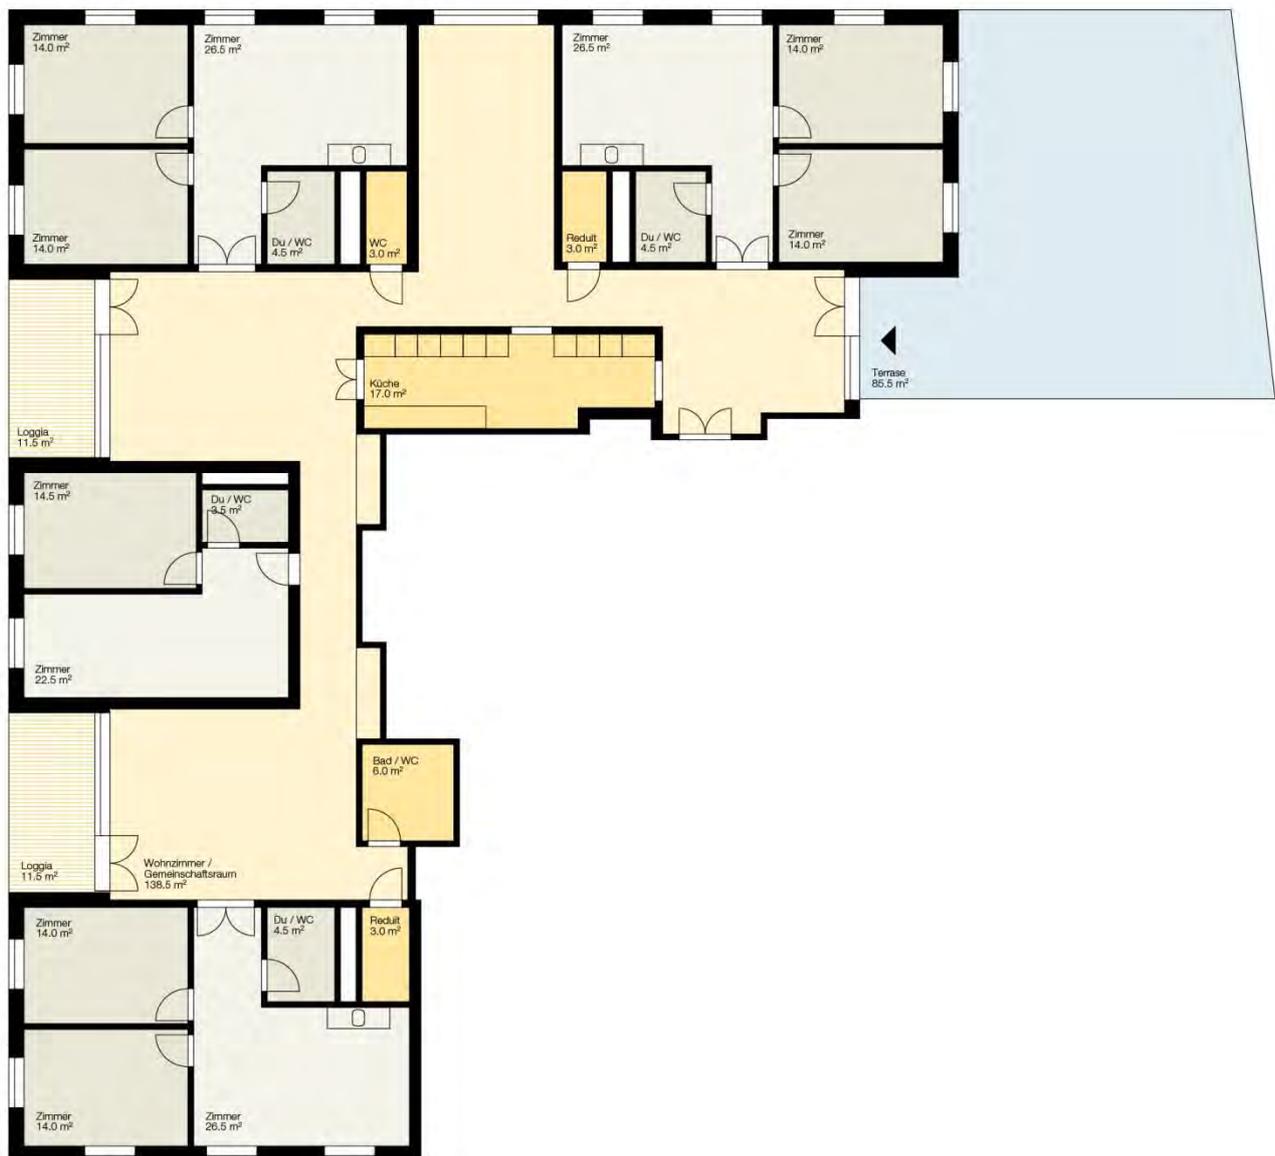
Grundriss der Clusterwohnung im 1. Obergeschoss
